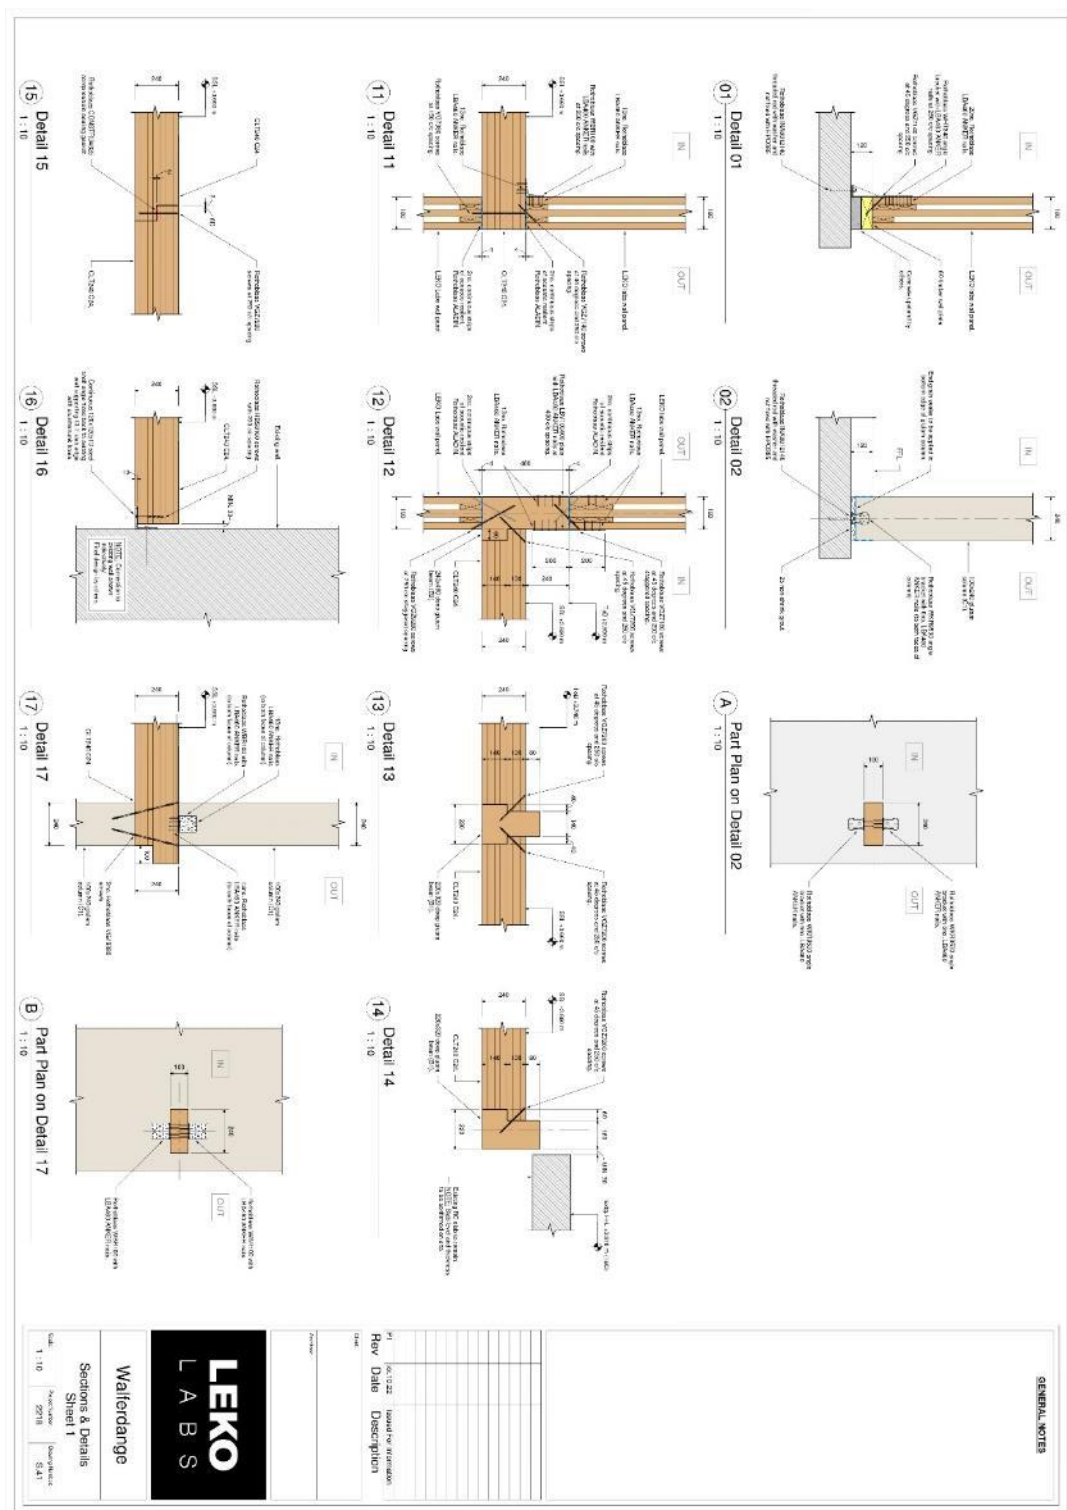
Exemples d'Interfaces LEKO LABS - Planchers CLT et poutres LC
